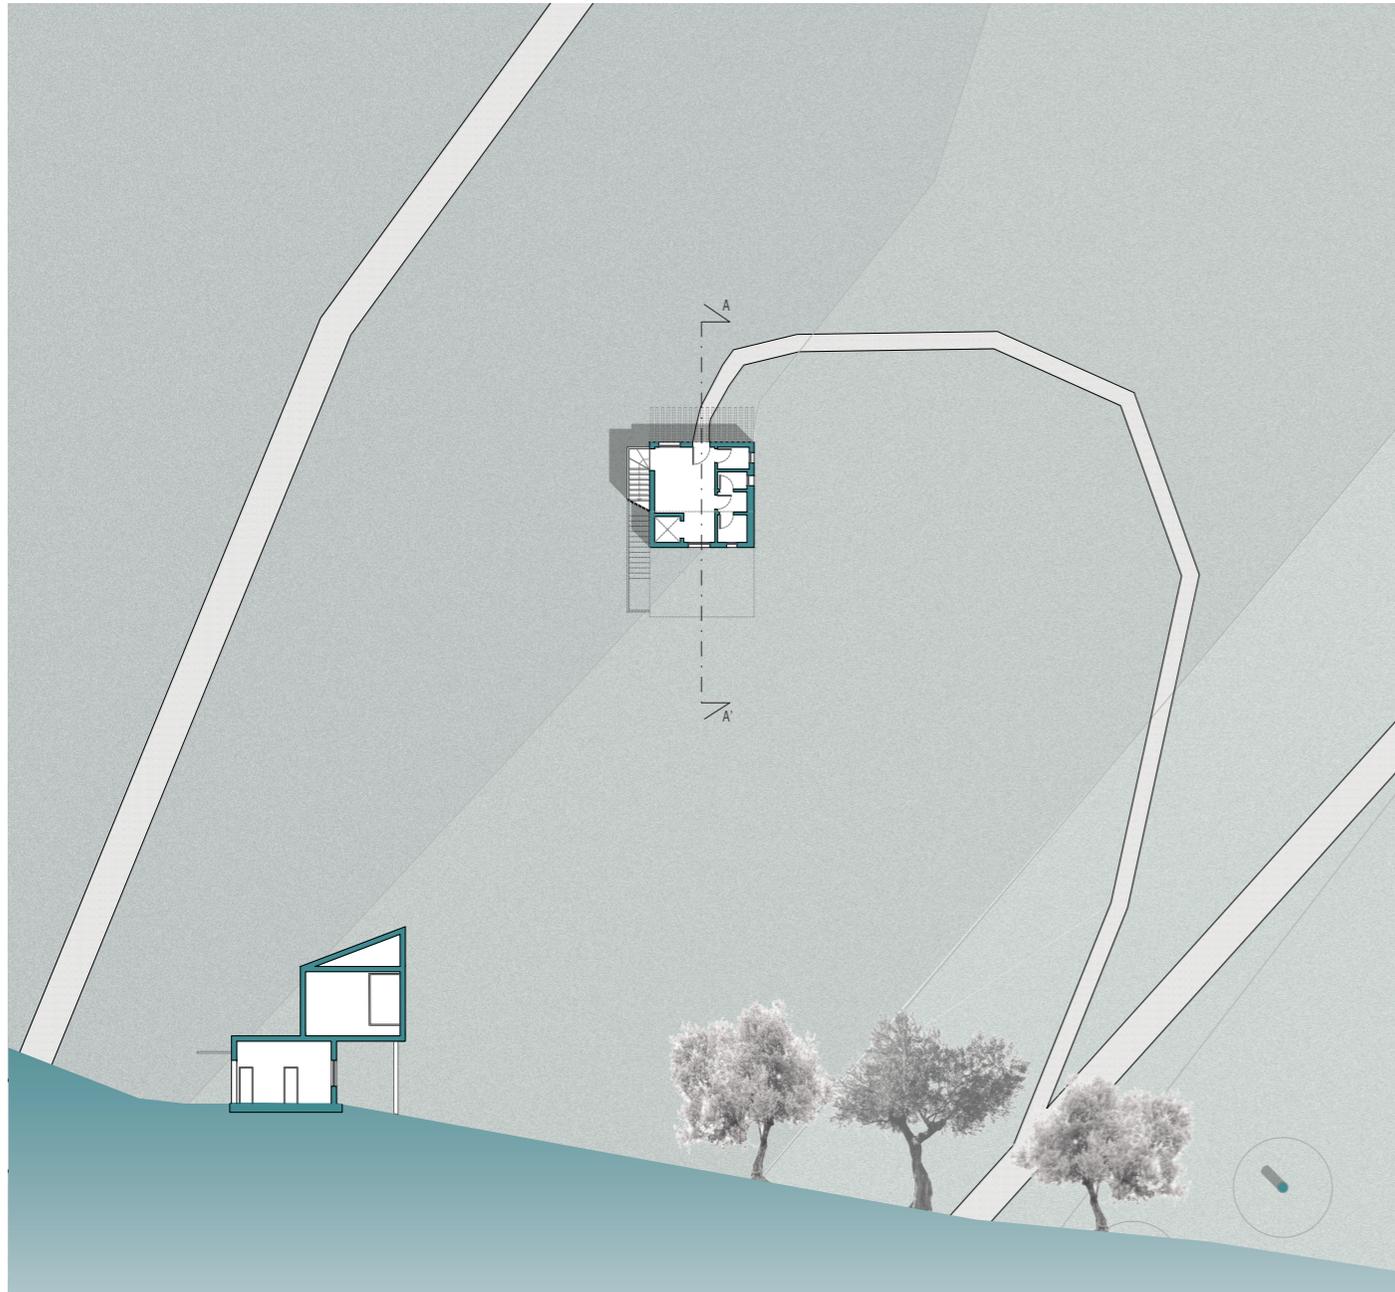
Pianta attacco a terra - sezione AA'. Scala 1:500
